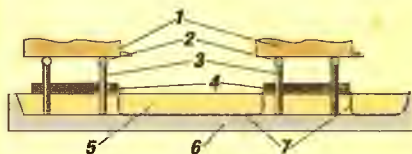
Пасека в разрезе: 1 — ульи; 2 — трубы (Ø15 мм); 3 — стойки из арматуры; 4 — бетонная стяжка (5 мм); 5 — песок; 6 — грунт; 7 — пленка
